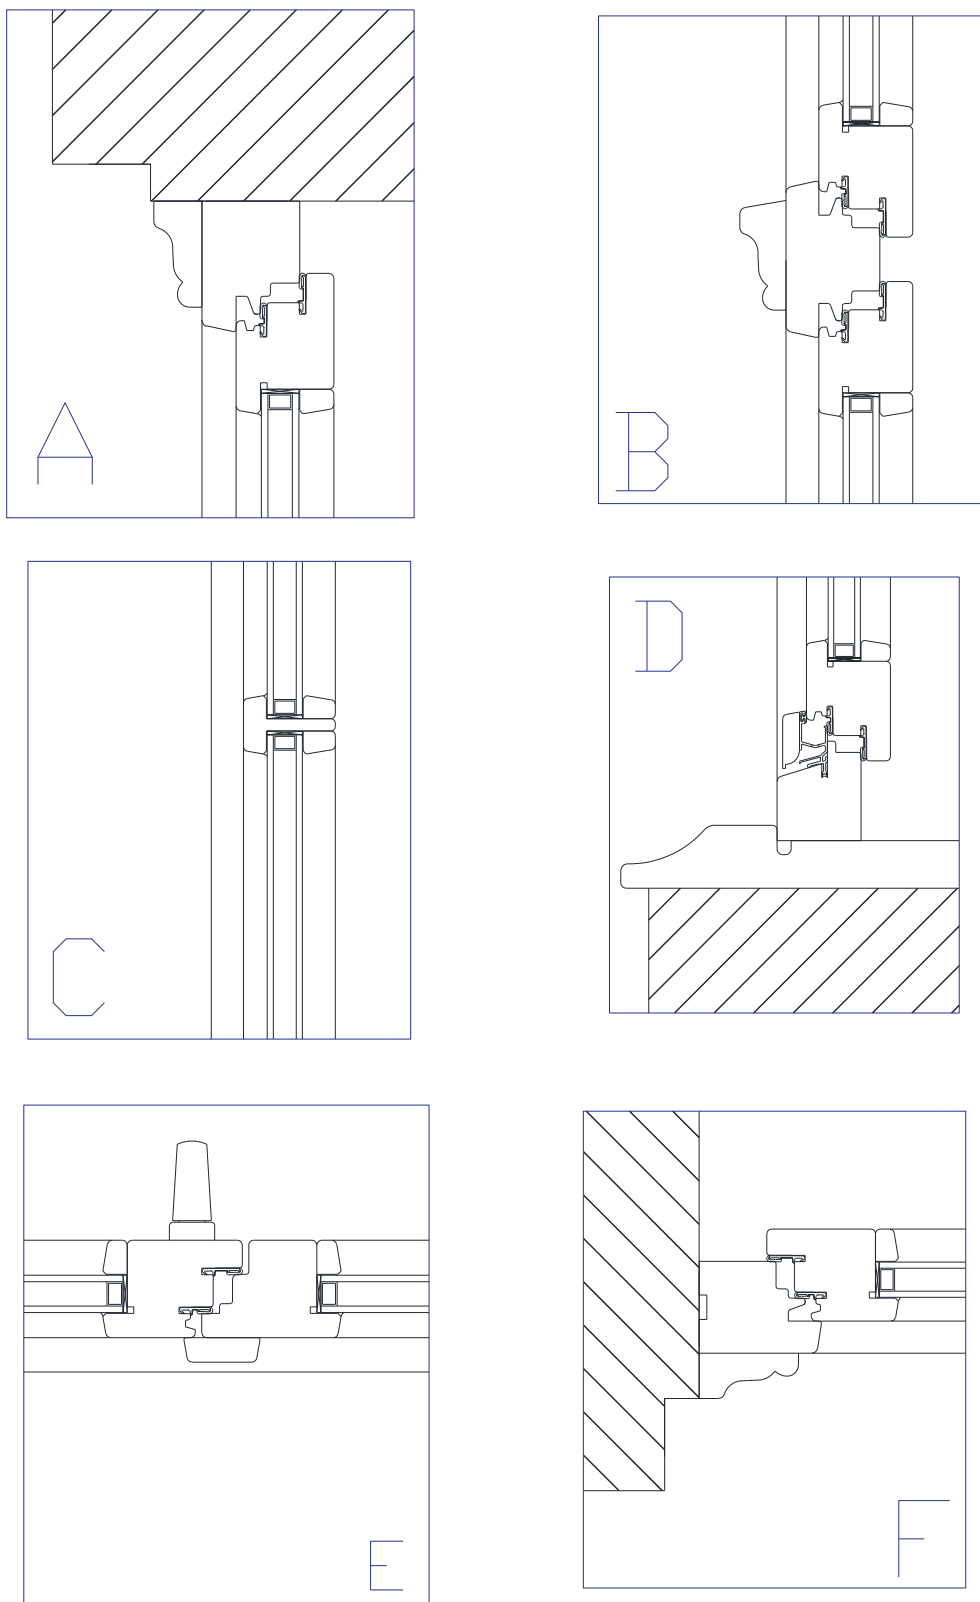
Pormenores de A a F do vão envidraçados de substituição.
